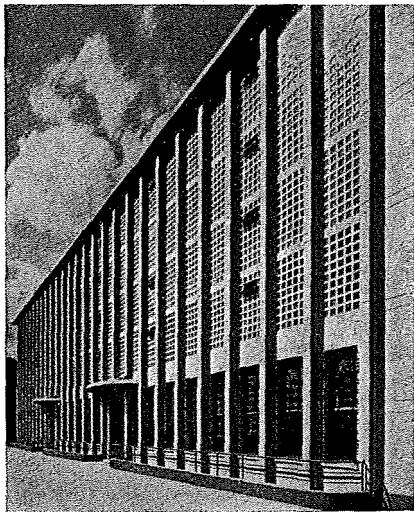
Bibliotheksdepot i Versailles. (Fotografi, Facade og Plan). Maal 1:1000. Brandsikker Jernbetonkonstruktion. Belysning gennem støvtætte Betonglas i Stedet for Vinduer. Søjleafstand bestemt af Reolopstillingen, saa Belastningen overføres direkte, og Gulvet kan udføres uden Dragere og Forstærkninger.
